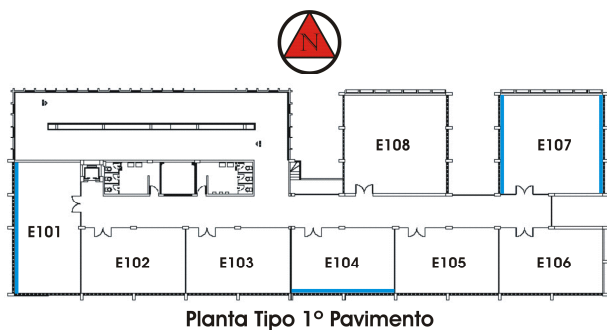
Planta Tipo 1º pavimento do Bloco E.
